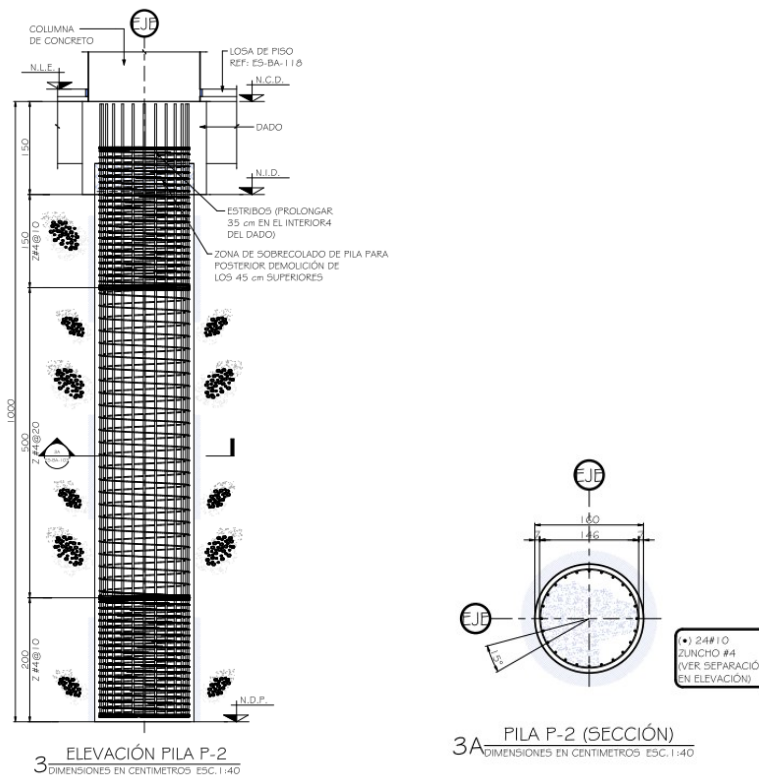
Detalle pila tipo P-2 con diámetro 1.60 m
